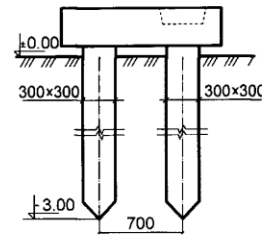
Фундамент з двома паями і збірним залізобетонним ростверком.
